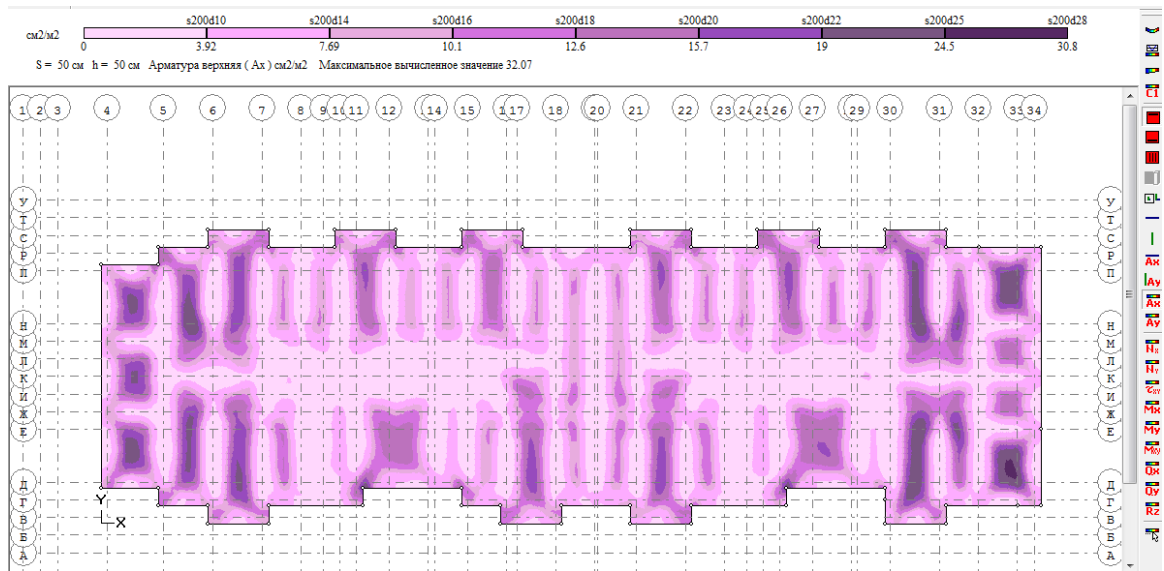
Діаметр і крок верхніх арматурних стержнів уздовж осі «x».
